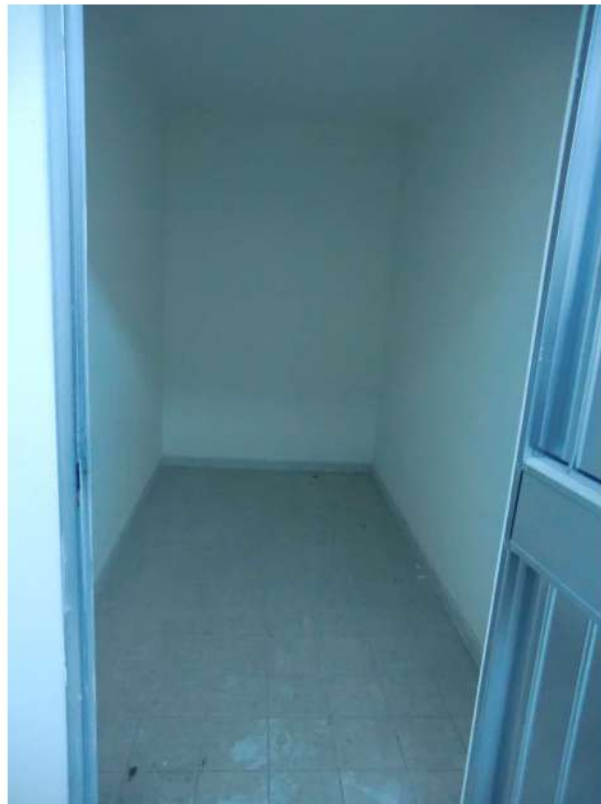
Via Is Arenas n.14. Cantina sub.22.
